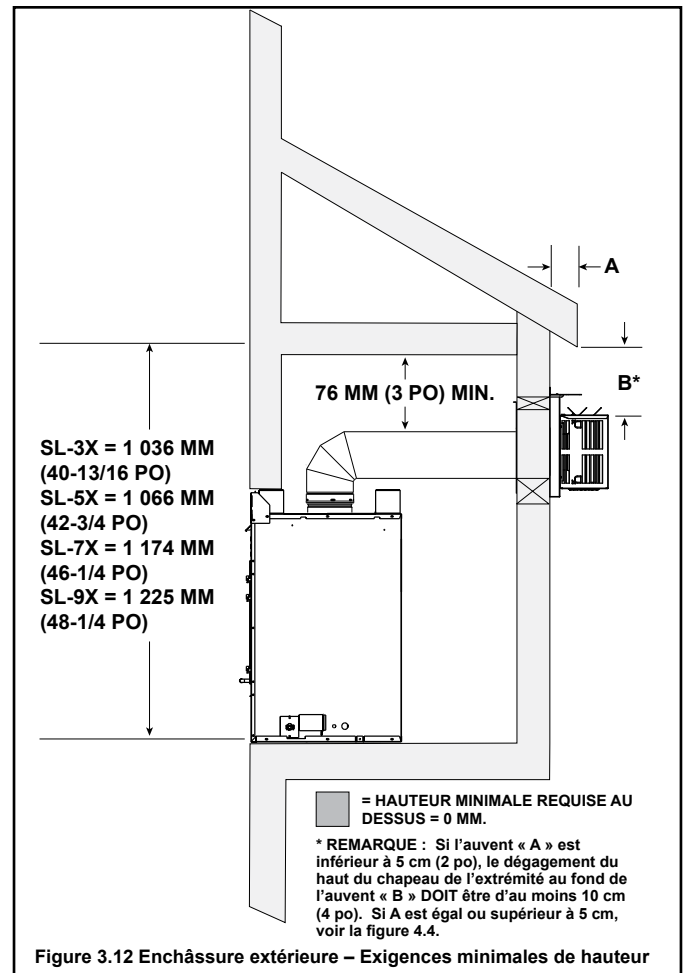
Enchâssure extérieure – Exigences minimales de hauteur
